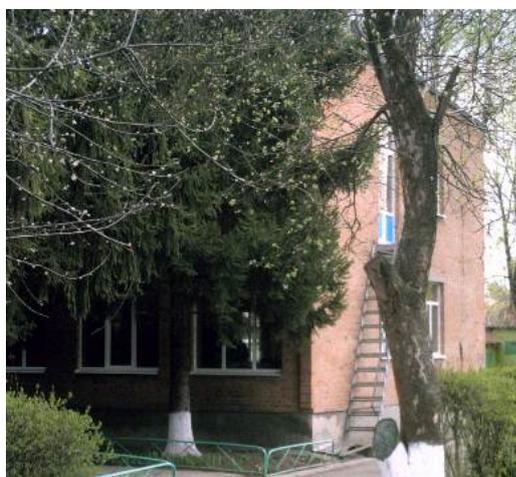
Торцеві фасади в осях 9-7/М, 6-4/Л і 3-1/К
